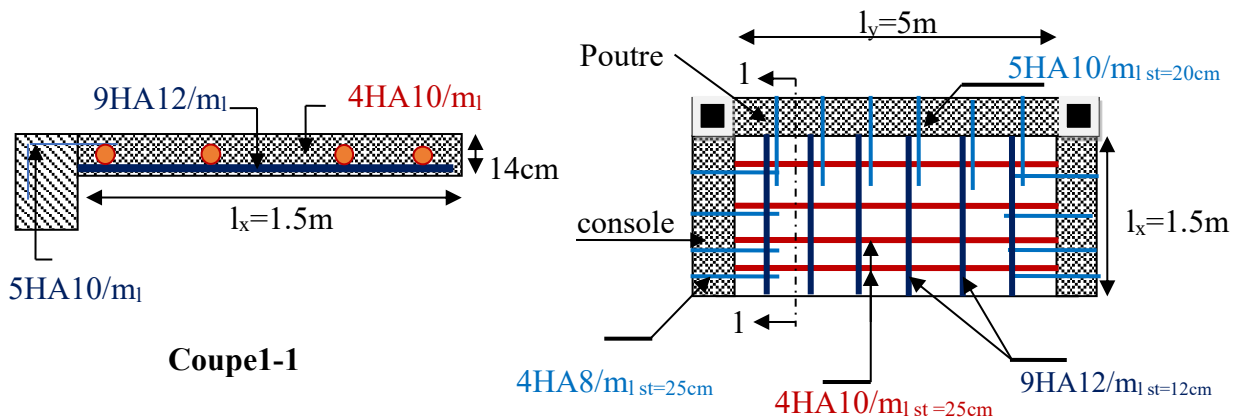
Schéma de ferrailage de dalle sur trois appuis
